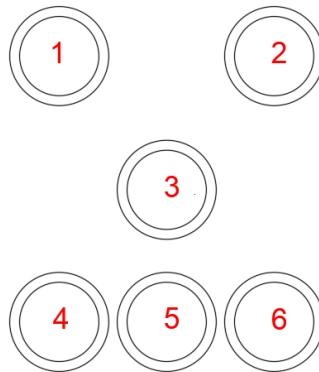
Sezione trasversale del Pilastro E, con numerazione dei culmi costituenti lo stesso.
